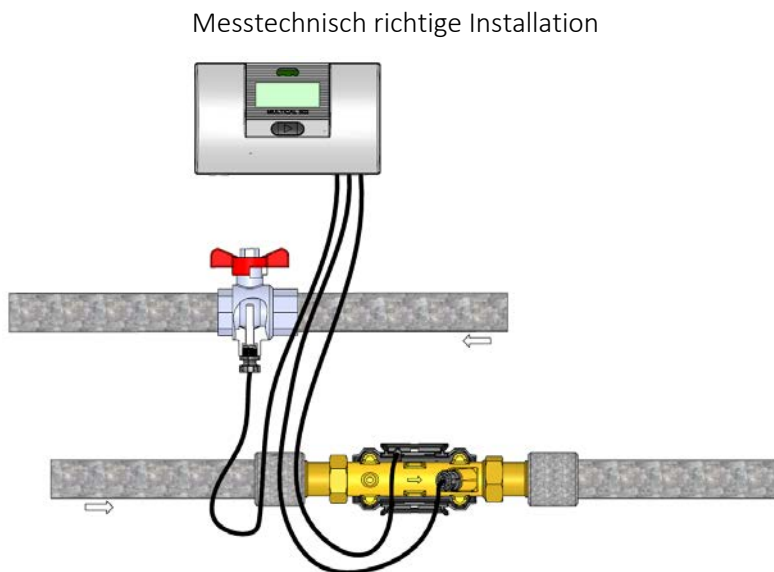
Beispiel für eine messtechnisch richtige Installation.
